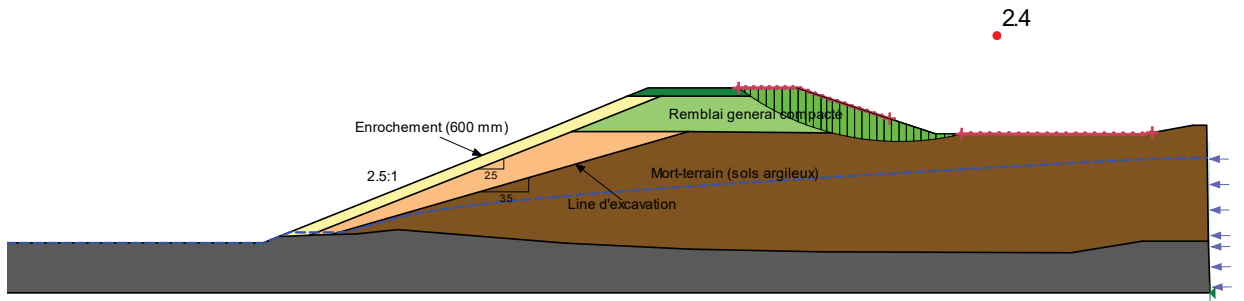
Stabilité long terme, pente externe de la digue, excavation dans des sols argileux
